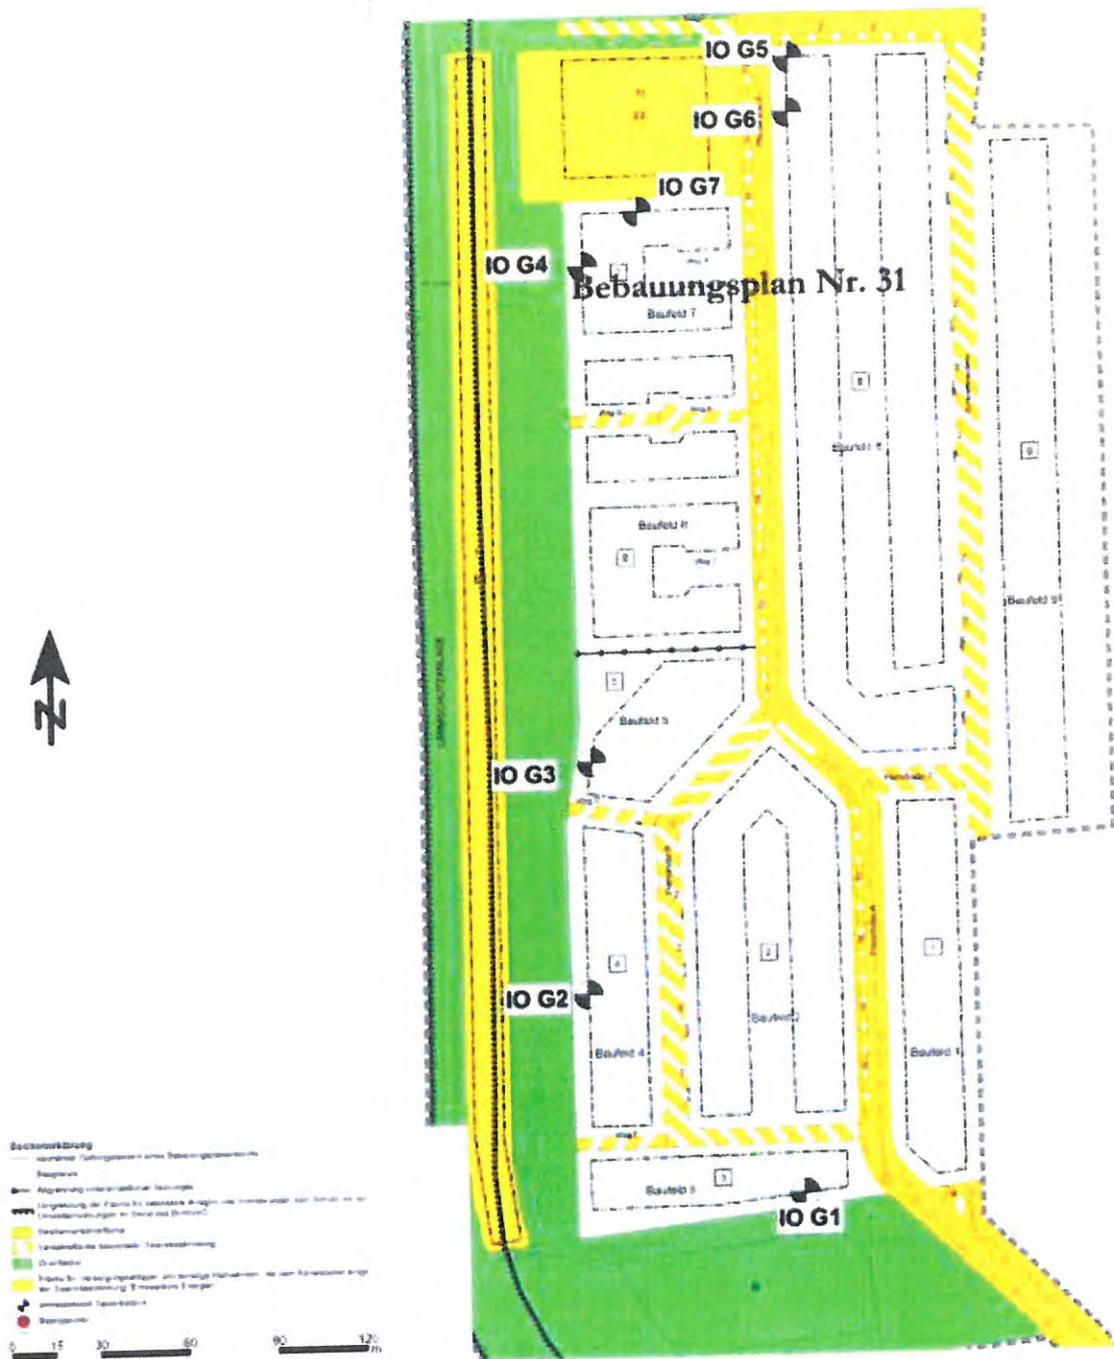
Lageplan mit Immissionsorten für die Gewerbelärberechnungen (IO Gx)
